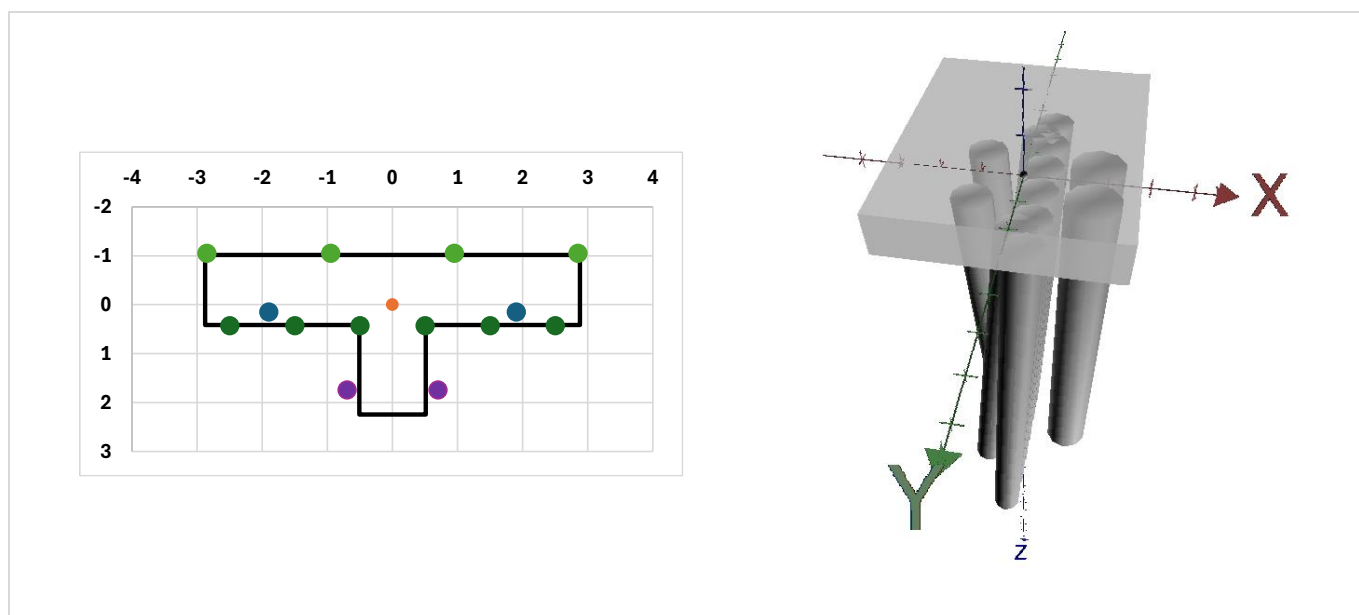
Calepinage des colonnes de jet grouting et modèle de la semelle de la fondation D (Conciergerie)
